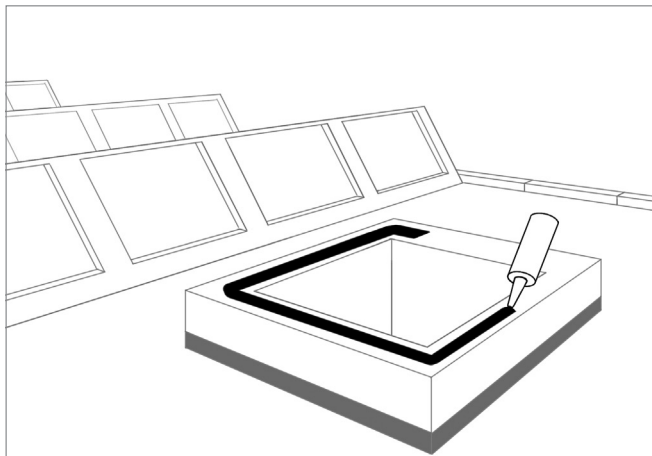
Application de produit d'étanchéité sur le socle de toiture
